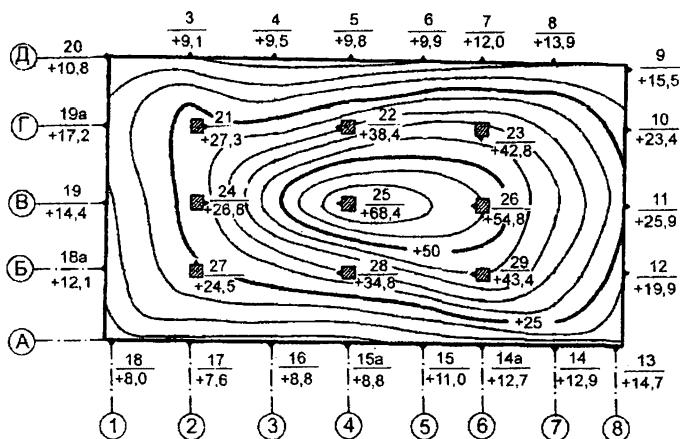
План осадочных марок фундамента с линиями равных осадок через 5 мм
